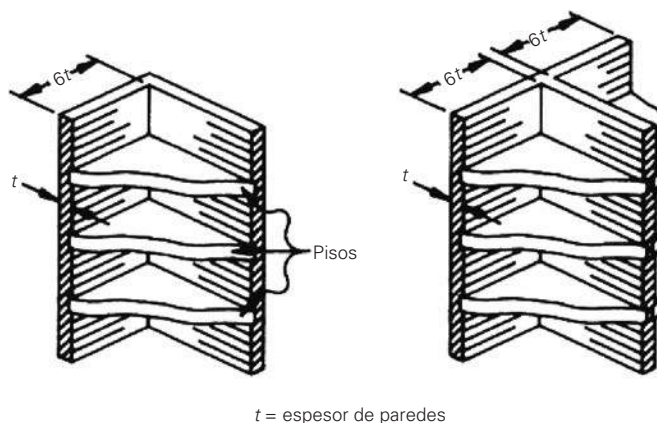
Ancho efectivo en las intersecciones de muros (Paulay, T. y Priestley, N., 1992)
